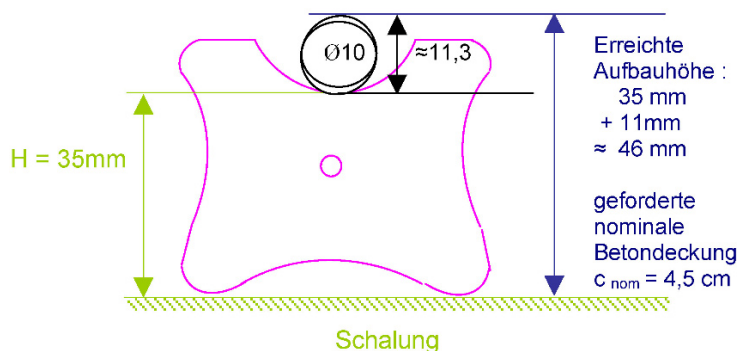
Stab-Knochen-Prinzip mit dem Montagestab und dem Abstandshalter im Maßaufbau
